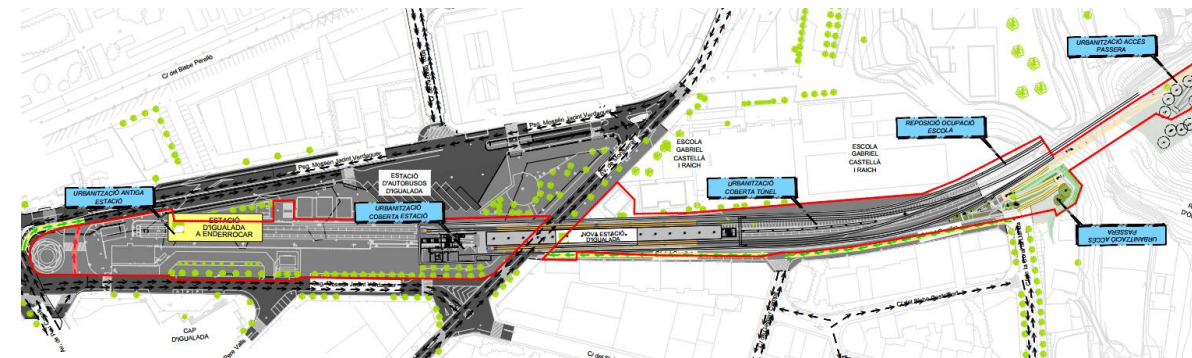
Àmbit d'obra Fase 5 alternativa 1 (font: elaboració pròpia)
